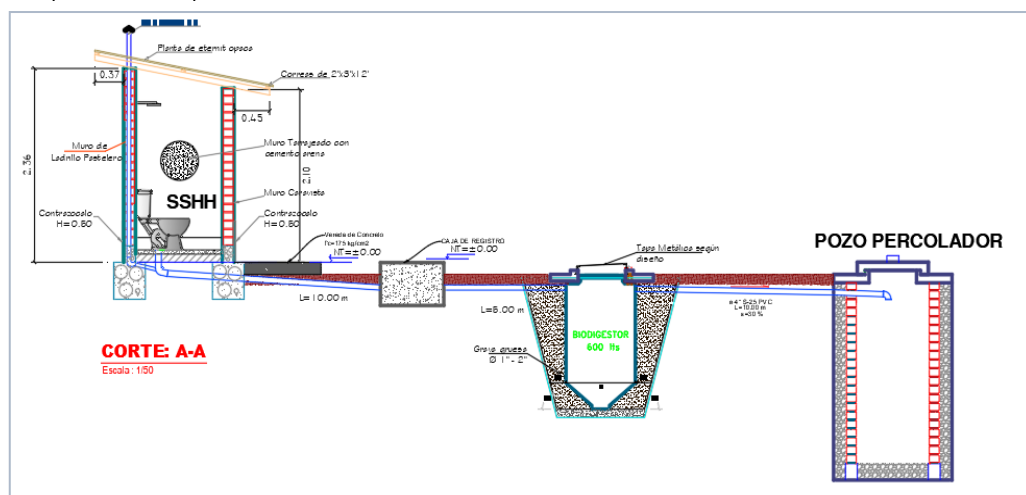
DETALLE UBS – ARRASTRE HIDRAULICO
